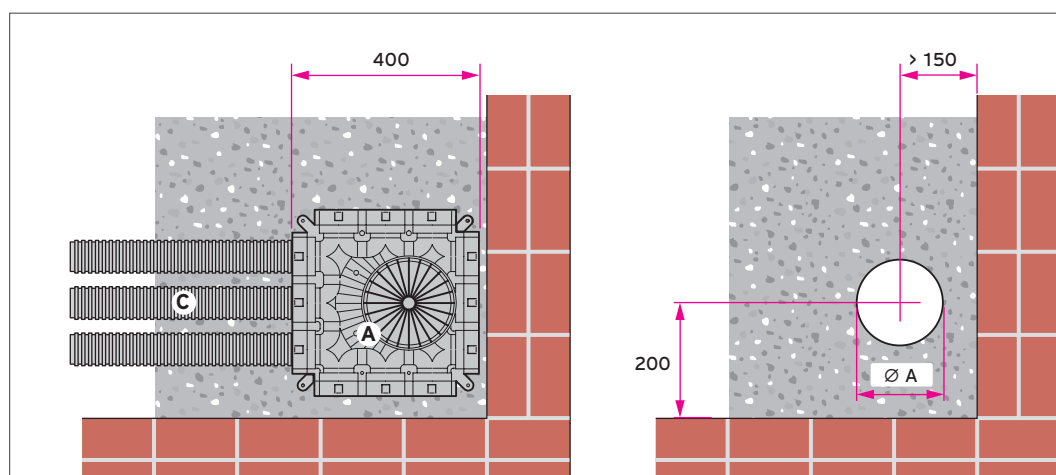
Niedrigbauverteiler/Sammler für runde Luftschläuche in der Rohbetondecke, Draufsicht
